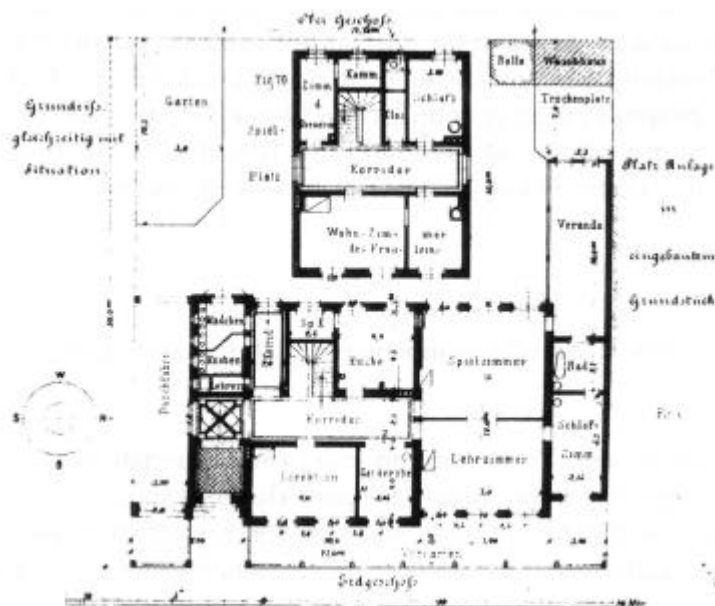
Erd- und Obergeschoßgrundriß einer Kinderbewahranstalt nach Reinhold Faber ¹
